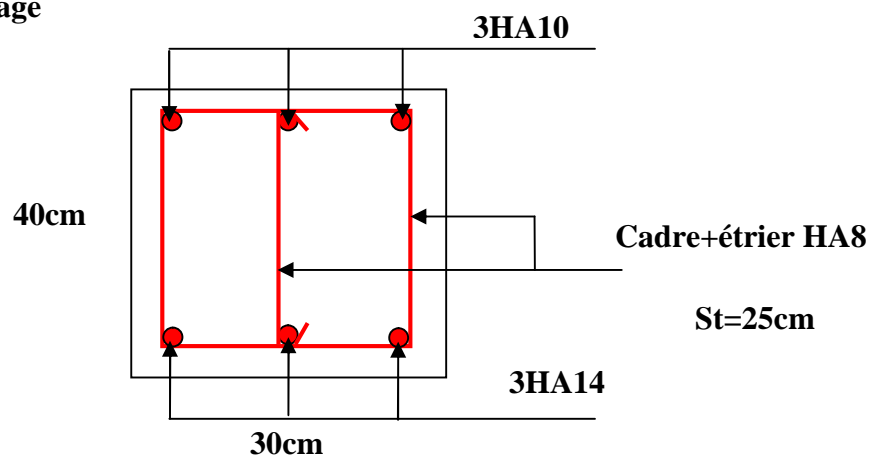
Schéma de ferrailage de la poutre de chaînage
